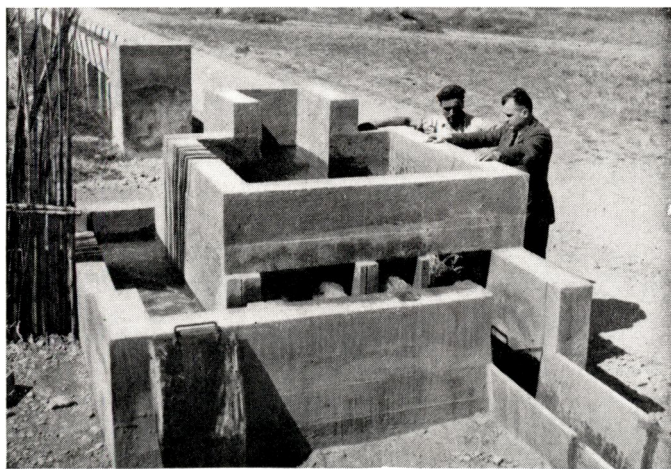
Tête en béton préfabriquée de distribution d'eau vers divers canaux.
